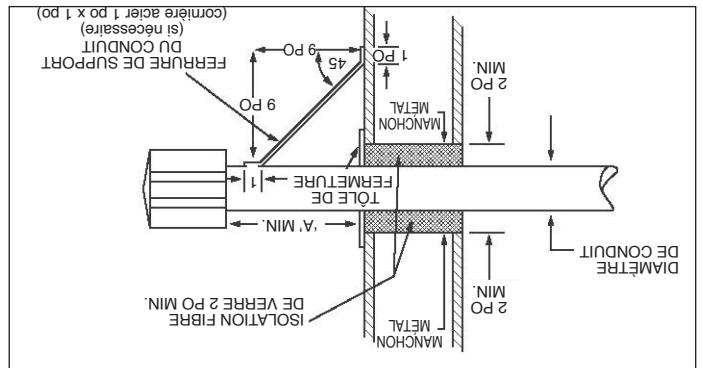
Construction d'une traversée à travers une paroi combustible et support de cheminée
